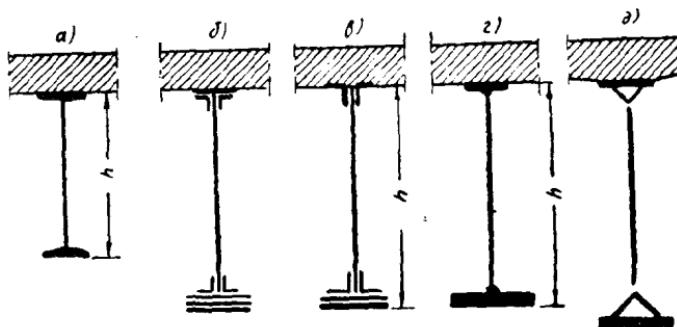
與鋼筋混凝土版共同受力的鋼梁斷面圖
